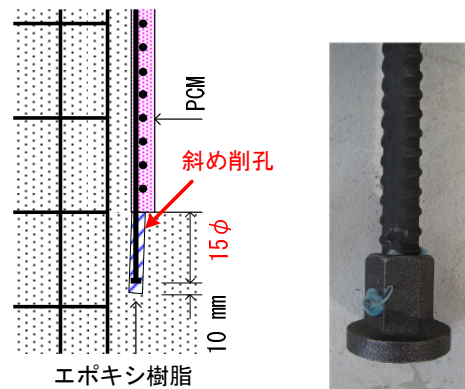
定着方法の概要 写真-1 定着用 T 形ナット
